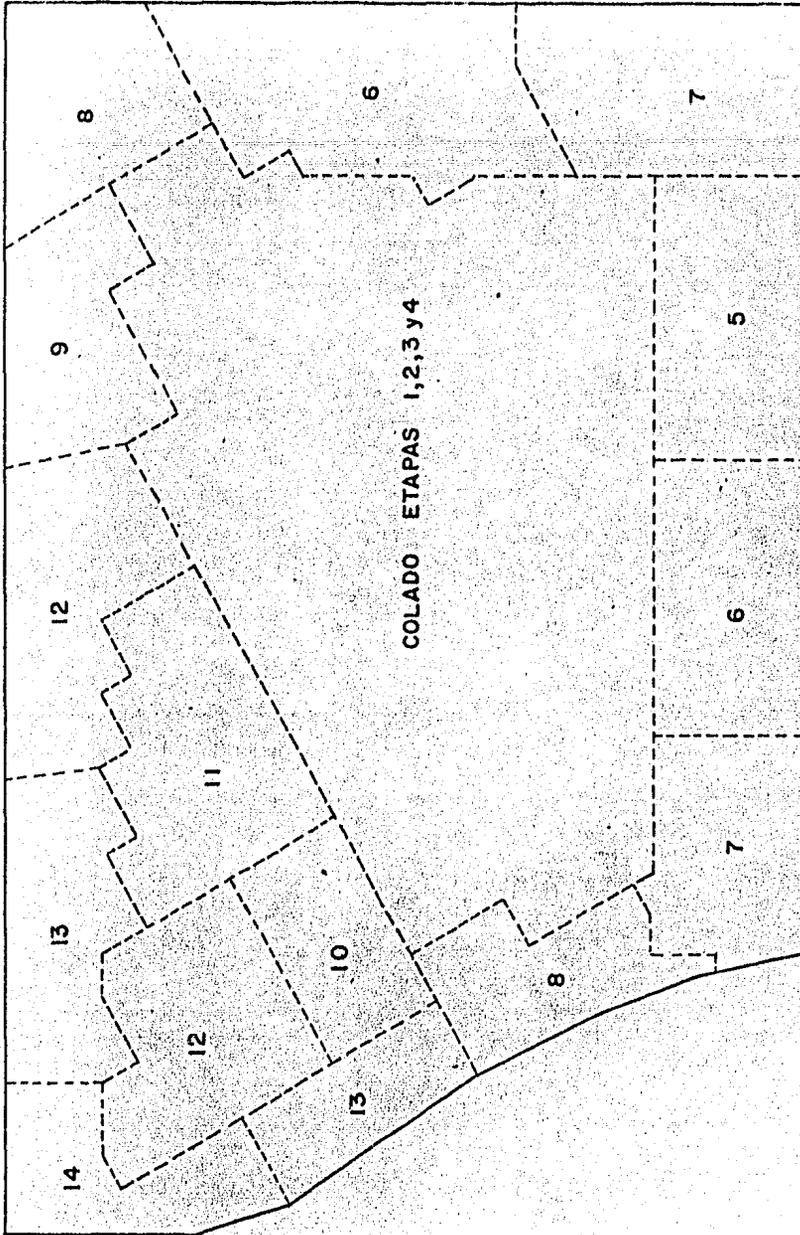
Planta esquemática de las diferentes etapas de construcción de la cimentación de un edificio alto en la zona del Lago del Valle de México.
